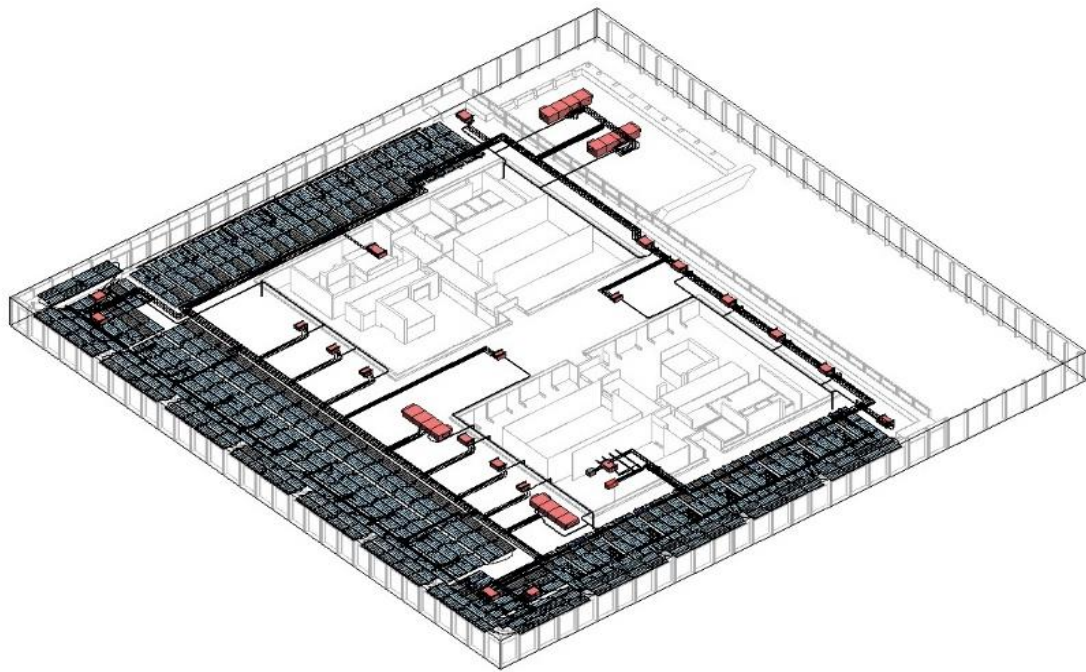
Rappresentazione modellazione idraulica piano tipo (Immagine estratta da elaborato Revit tesi)
